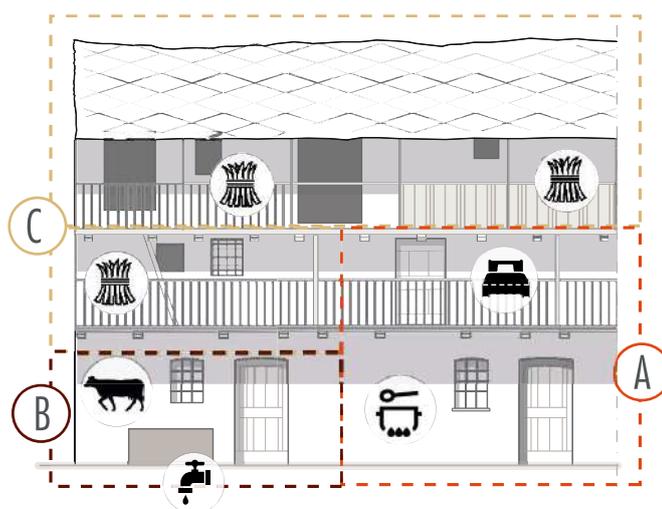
Schematizzazione prospettica dell'edificio 30, lato ovest
